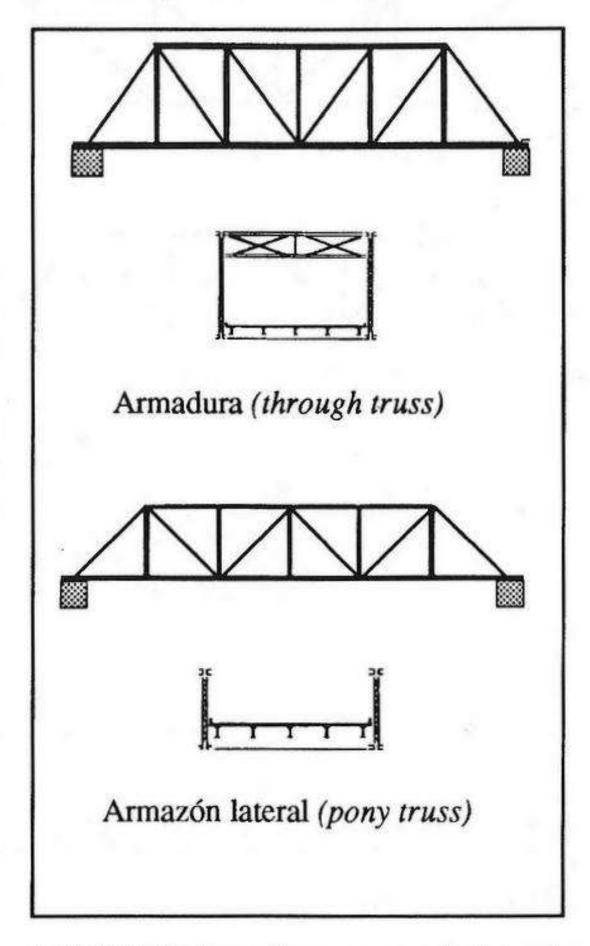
Armadura y armazón lateral, ambas de tablero inferior.
